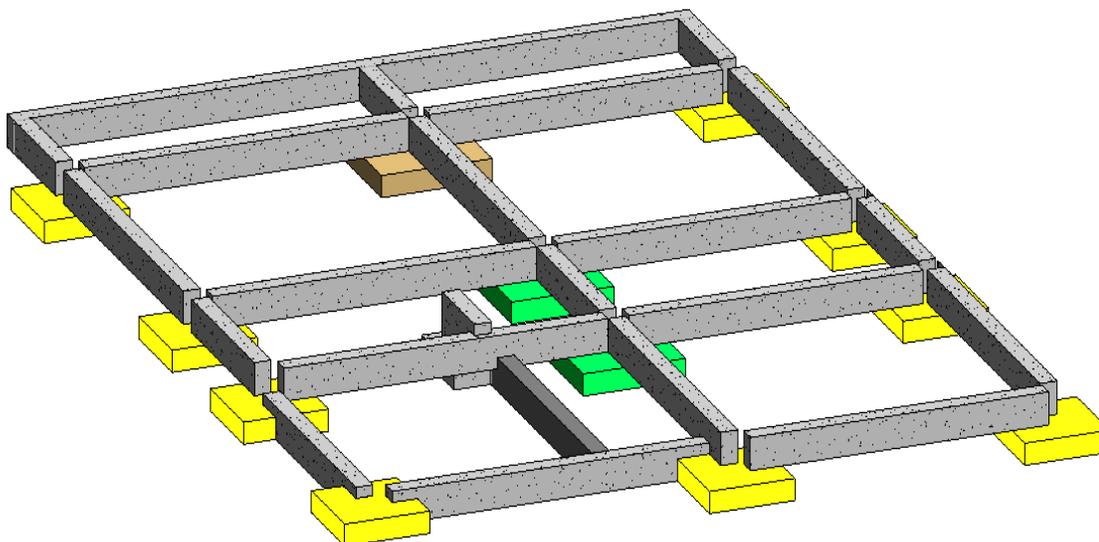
Zapata aislada tipo 1 modelado en Revit. (Inmovila 2023)
